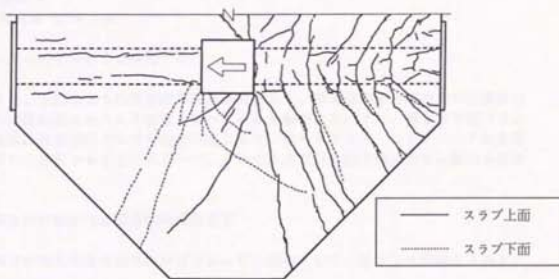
正方向加力時のスラブ上下面のひびわれ状況 (試験体 A 4)
